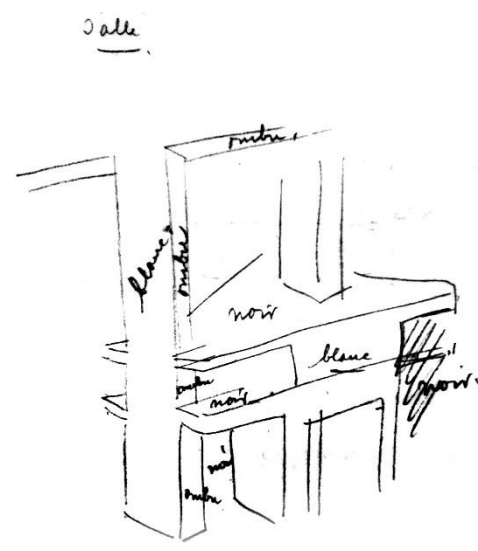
Chimenea con doble hogar en el salón (salle à manger).
